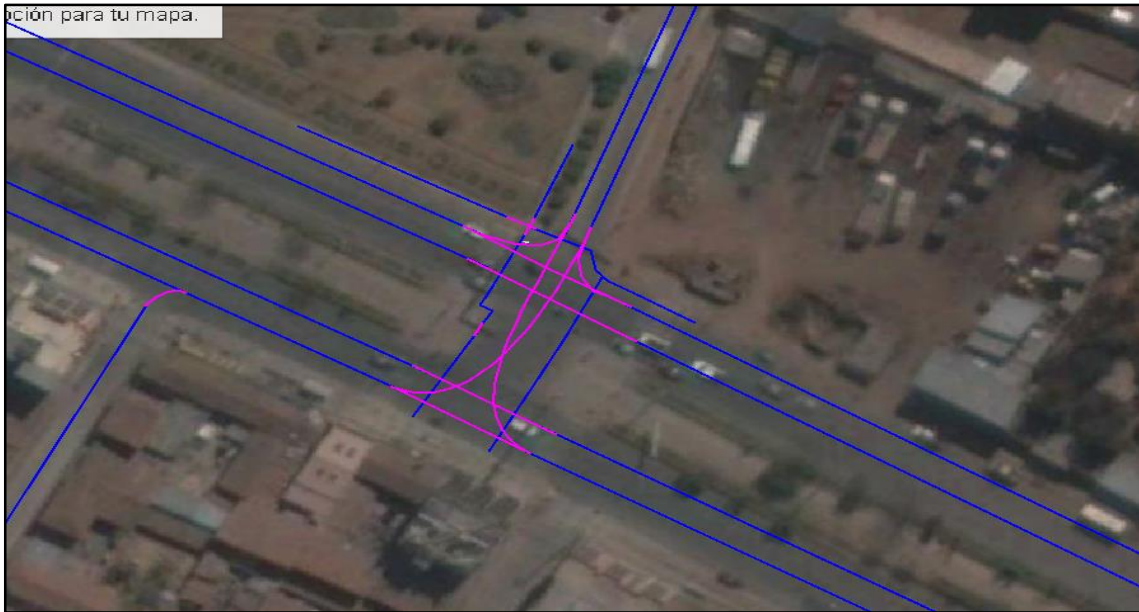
Vista en planta de la Intersección Prolongación Av. La cultura – Universidad Andina del Cusco
